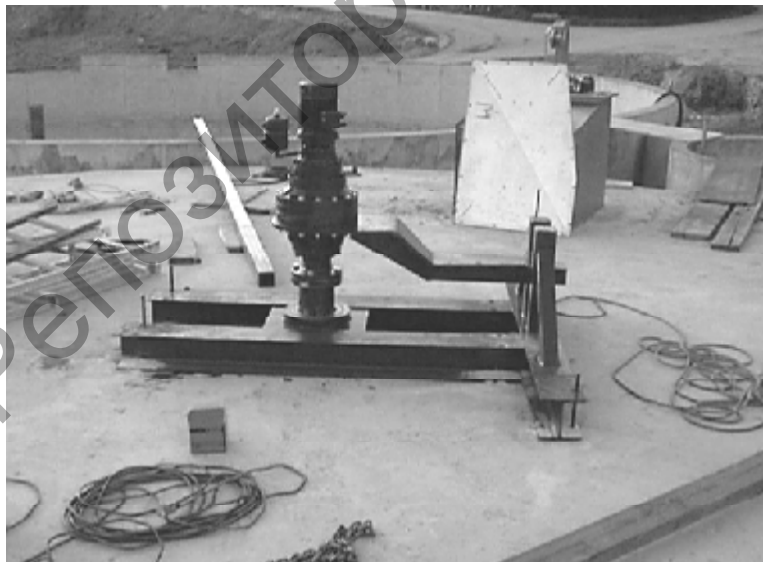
Строительство перекрытия ферментатора [82]
